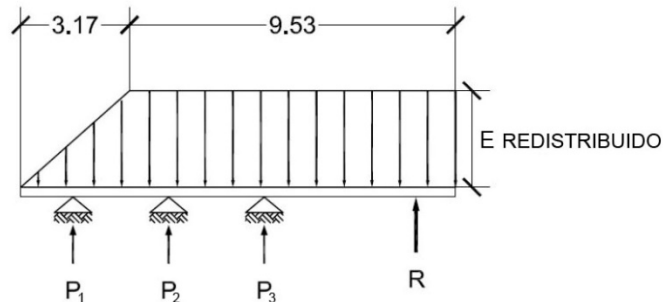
Análisis de la tablestaca como viga simplemente apoyada.
